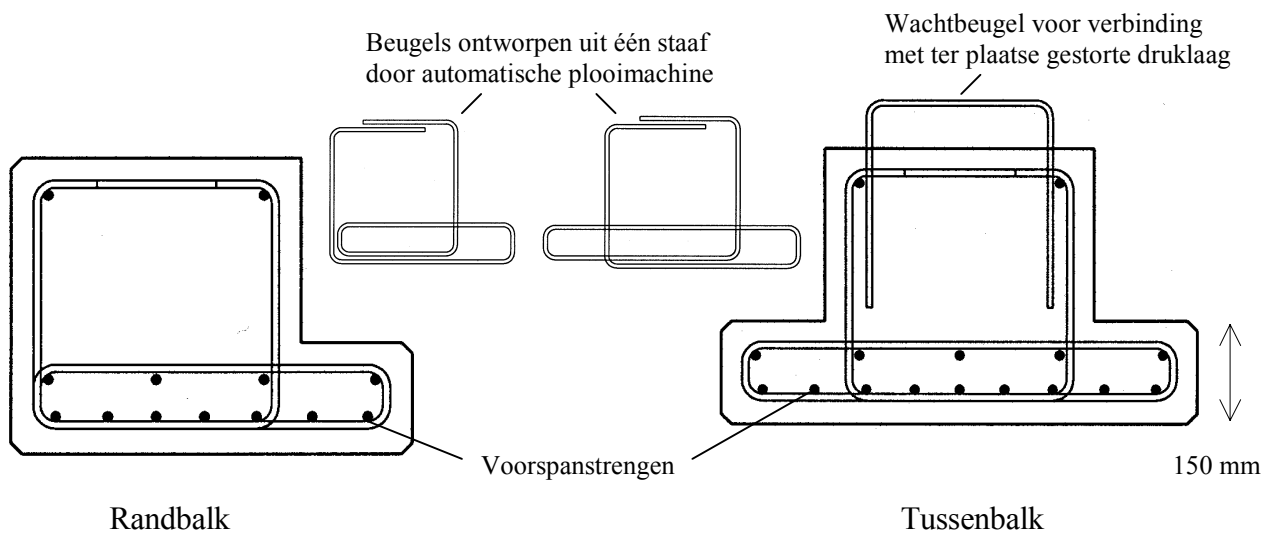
Voorbeelden van wapening van vloerbalken met hielopleggingen
